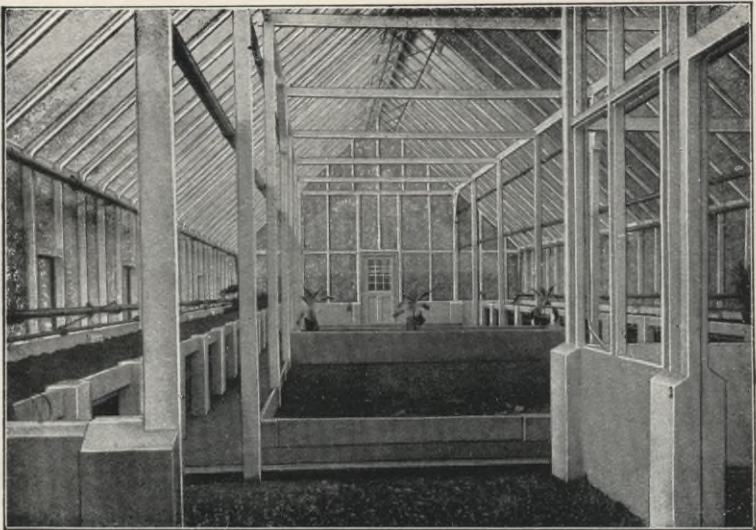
Gewächshaus aus Eisenbeton. Innenansicht.
